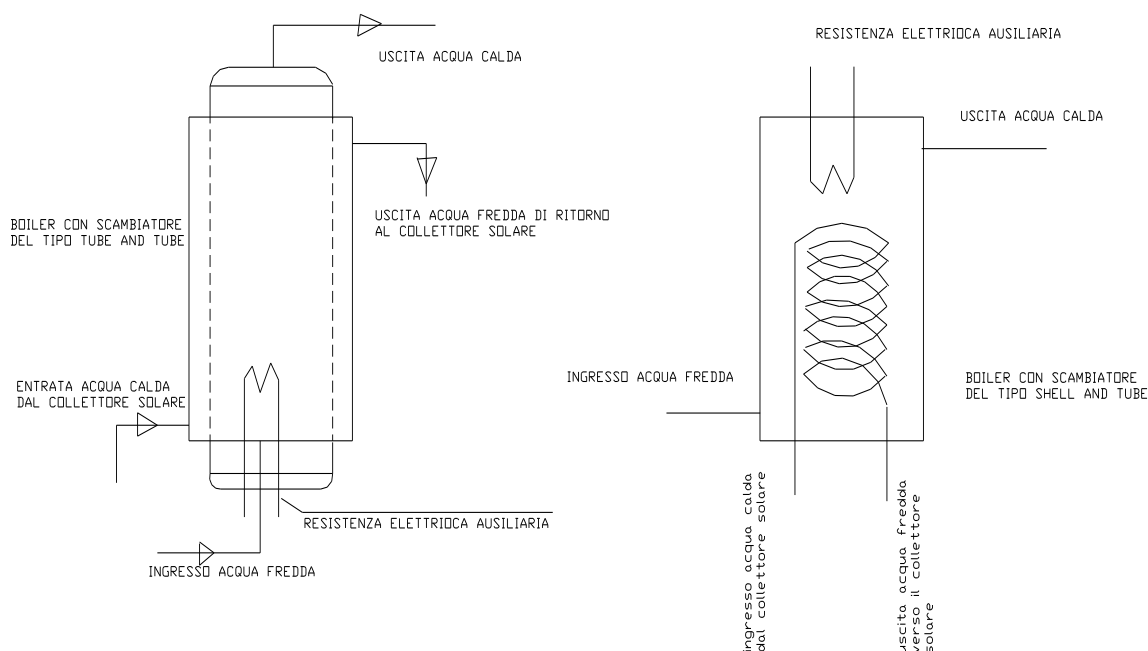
Boiler per sistemi localizzati con scambiatore del tipo tube and tube e a shell and tube
